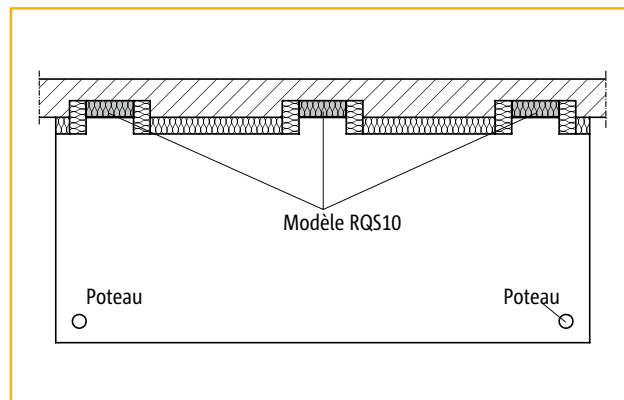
montage d'un balcon sur une dalle existante avec modèle RQS, construction soutenue
